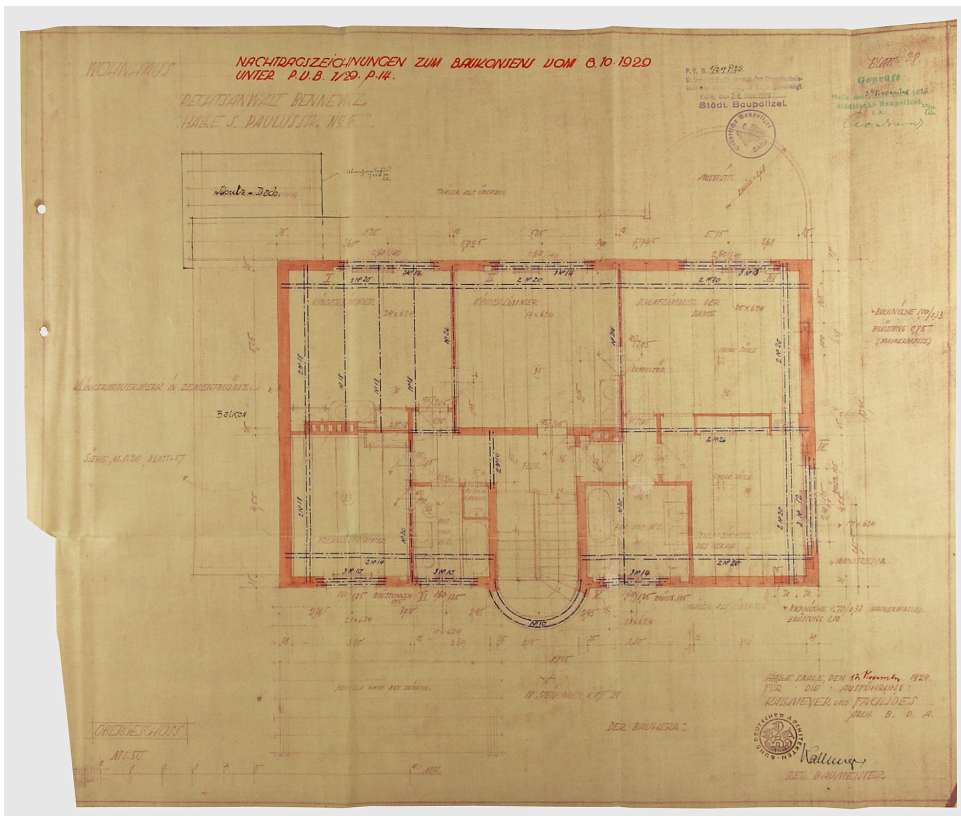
Wohnhaus in der Heinrich-Heine-Straße 6 in Halle, Grundriss erstes Obergeschoss, datiert 12. November 1929.
